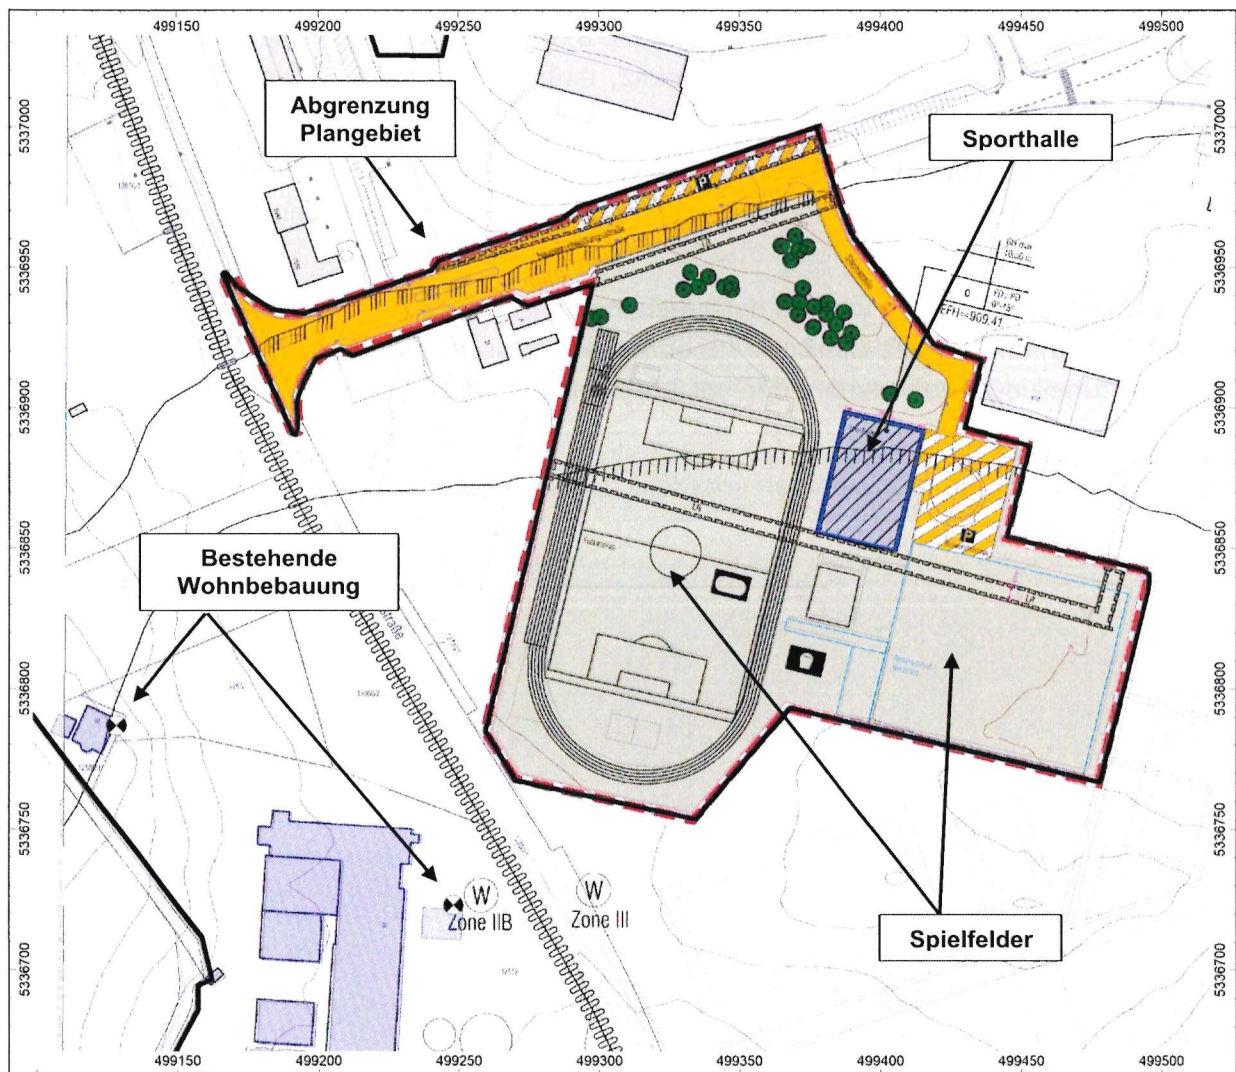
Planzeichnung zum Bebauungsplan „Sportflächen Geißbühl“ nach aktuellem Planungsstand /14/
